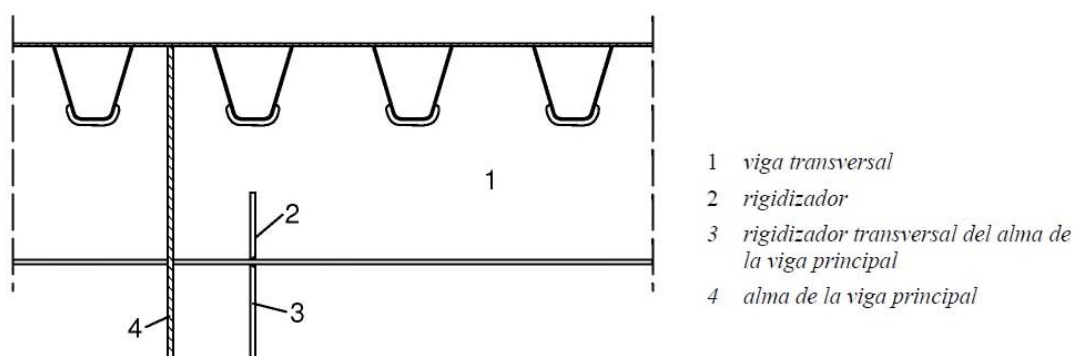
C.15 Unión tipo de vigas transversales a rigidizadores transversales del alma de las vigas principales
